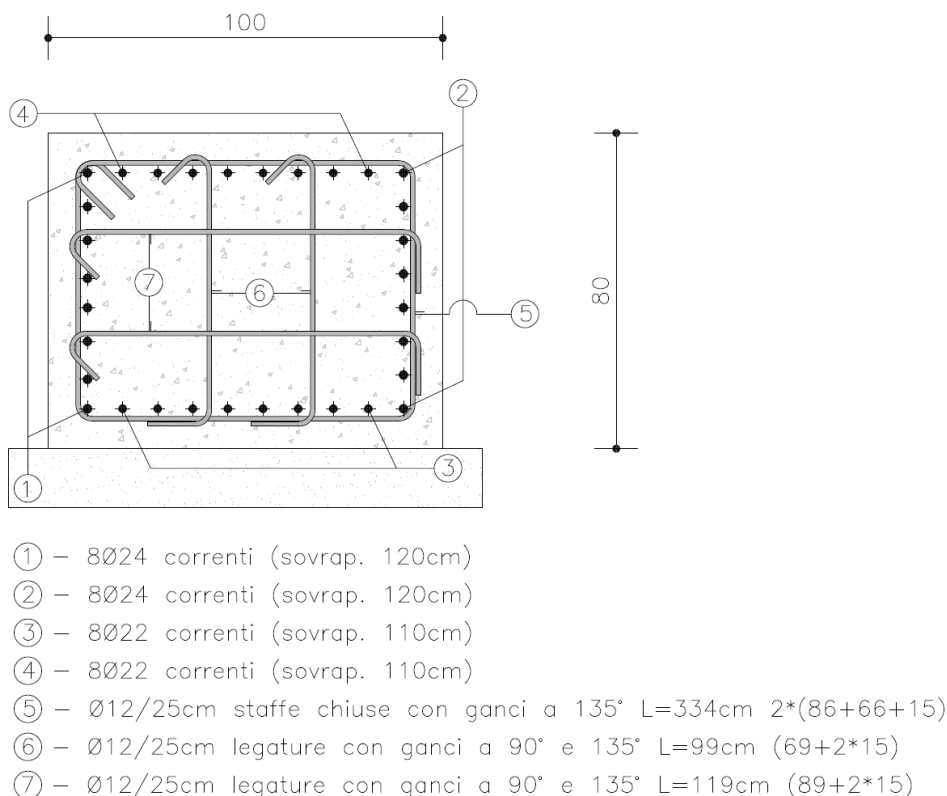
Cordolo porta barriera – sezione trasversale con armatura
